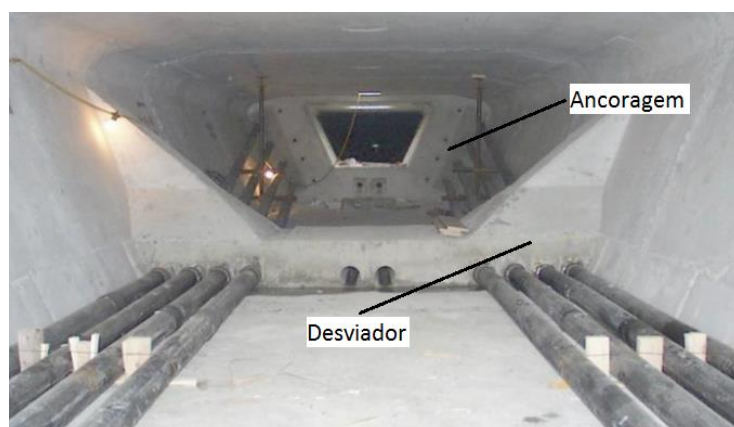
Sistema de pré-esforço exterior (Adaptado de FIGG)
